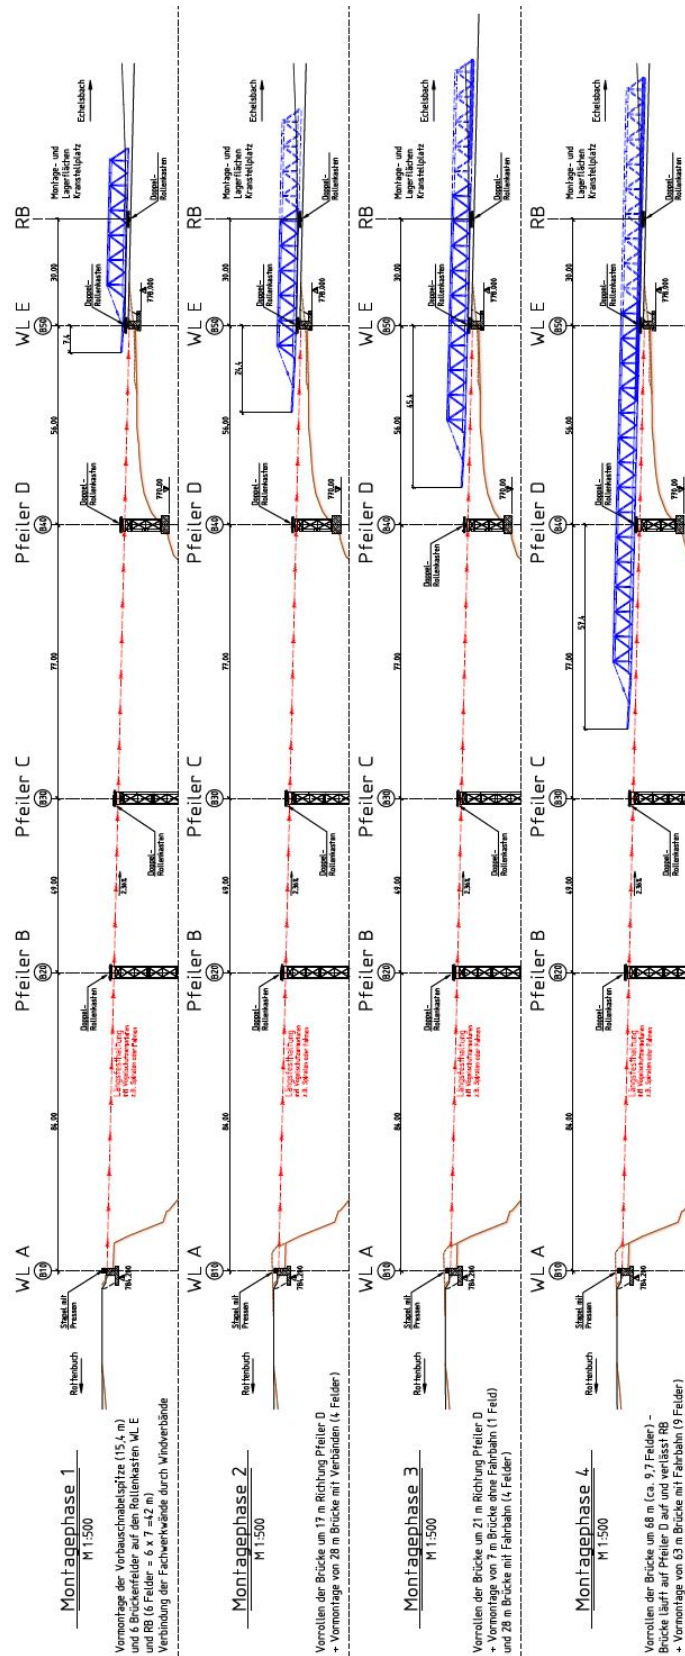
Ausschnitt aus dem Montageplan zum Bau der Behelfsbrücke Echelsbach [55]
